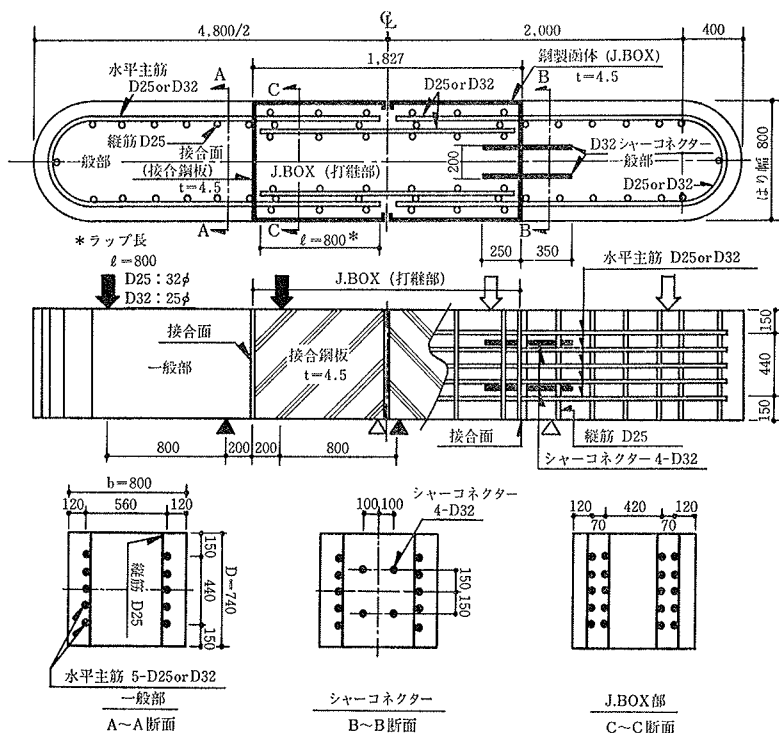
試験体の断面形状・配筋図 (IN S シリーズ)
